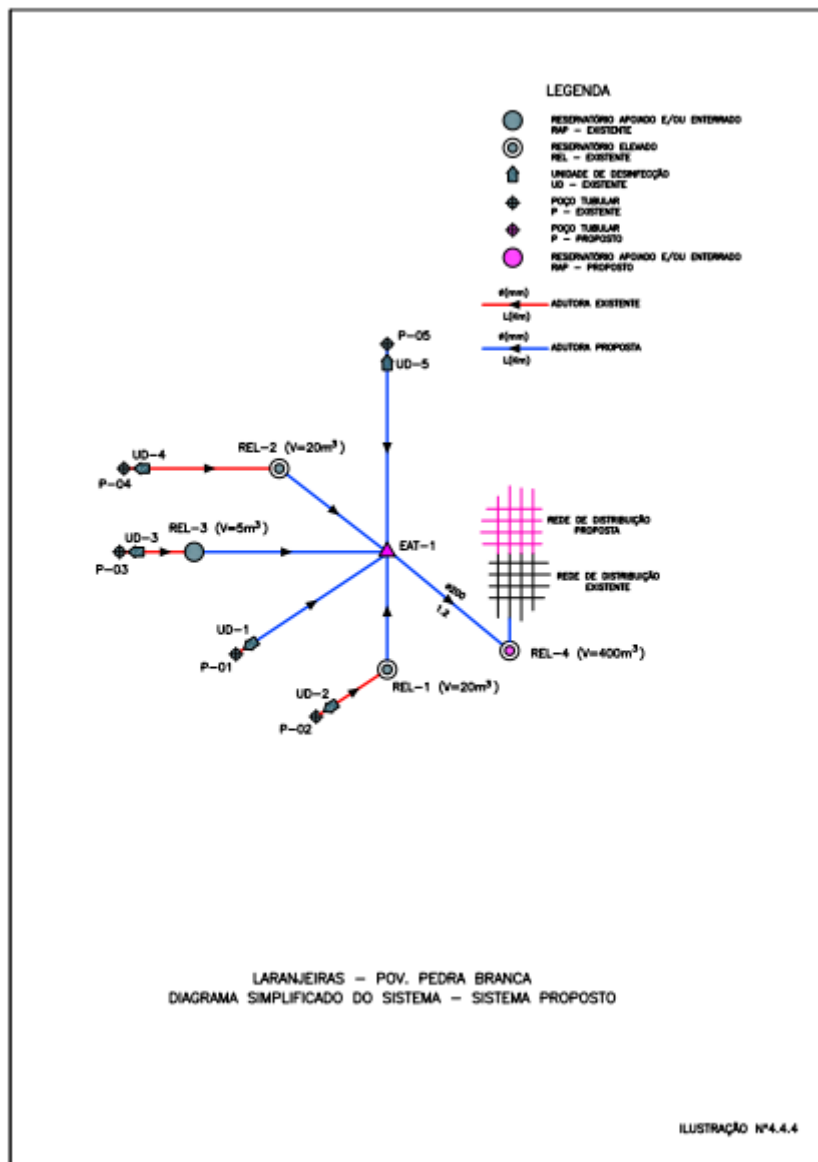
Diagrama simplificado do sistema proposto – Pov. Pedra Branca
